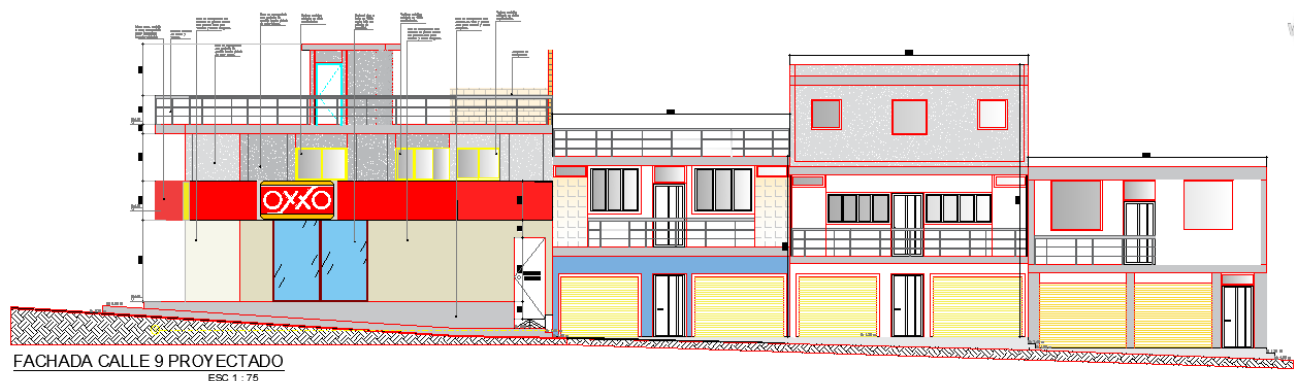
Fachada calle 9 proyectada OXXO UNIVERSIDAD. Fuente propia.
